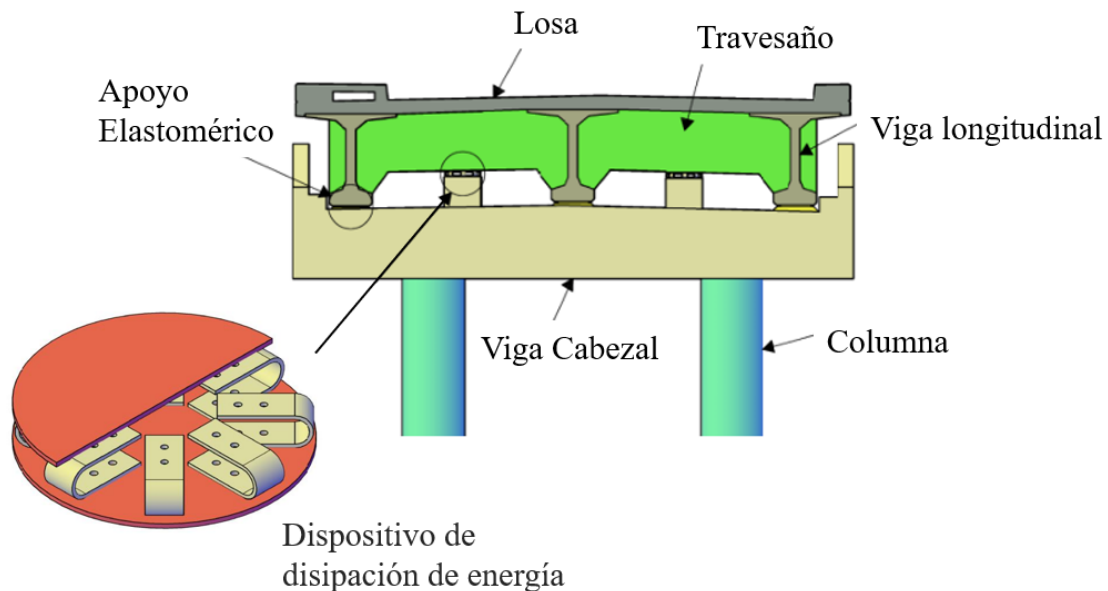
Esquema de aplicación de dispositivos *U-Shaped* tipo Crawler en un puente, en conjunto con apoyos elastoméricos y la subestructura de hormigón.
